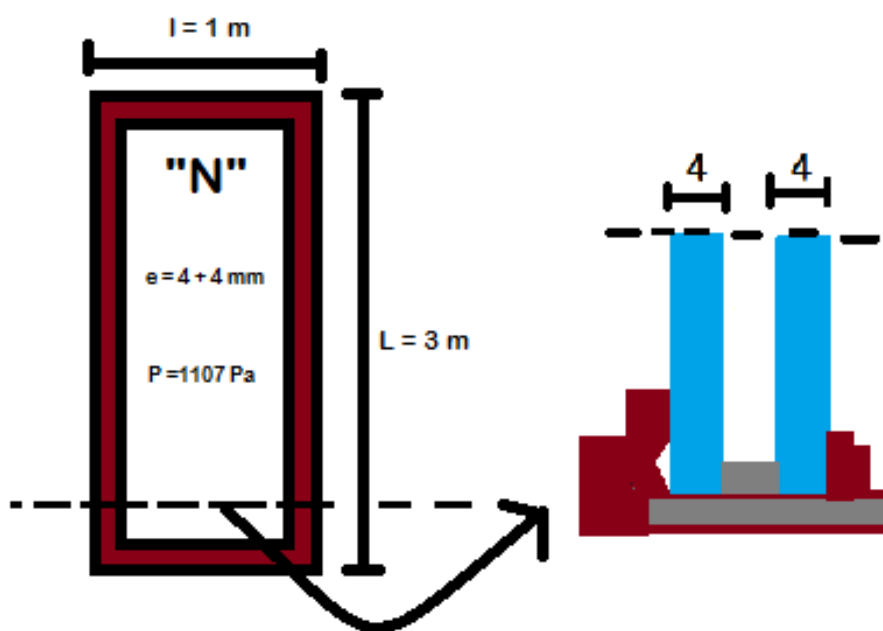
Esquema do Envidraçado "N" em corte e em planta
